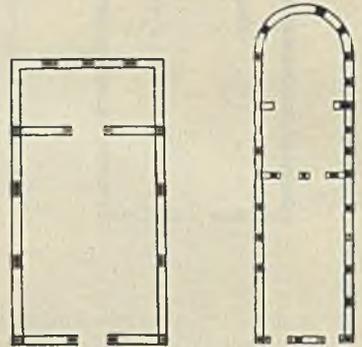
Grundrisse einschiffiger Kirchen in Nordafrika. (Nach Witting)
